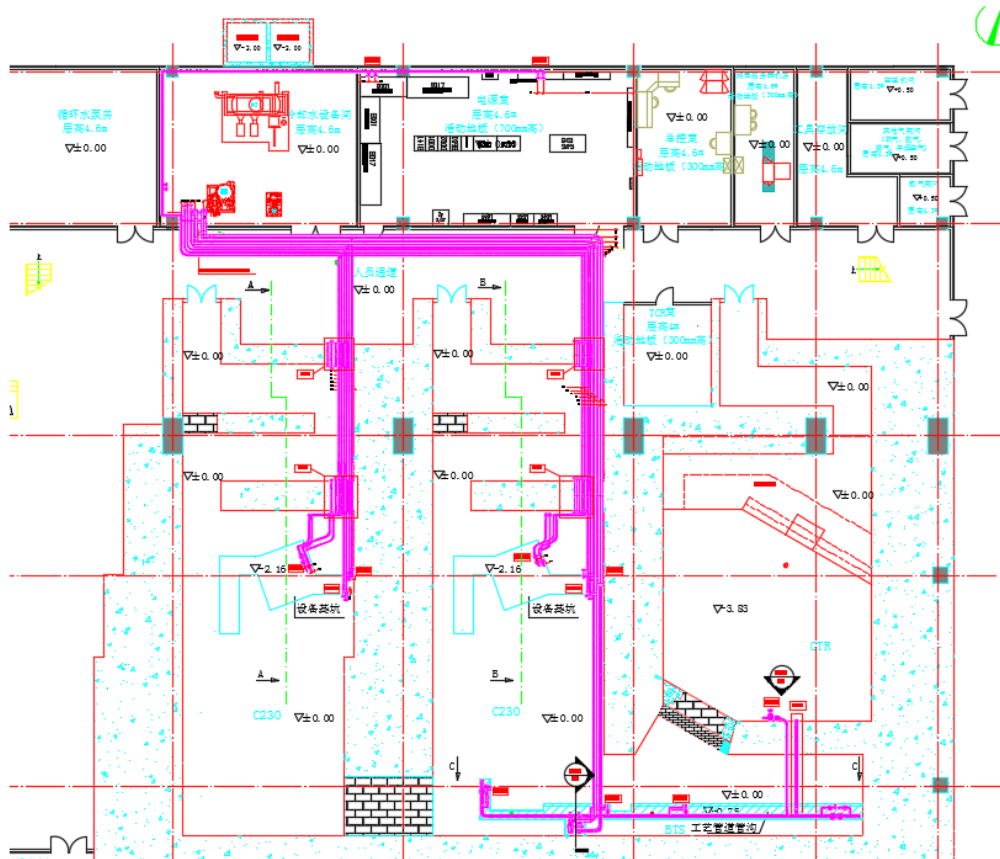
冷却水管线穿越屏蔽墙体示意图（平面布置图）
